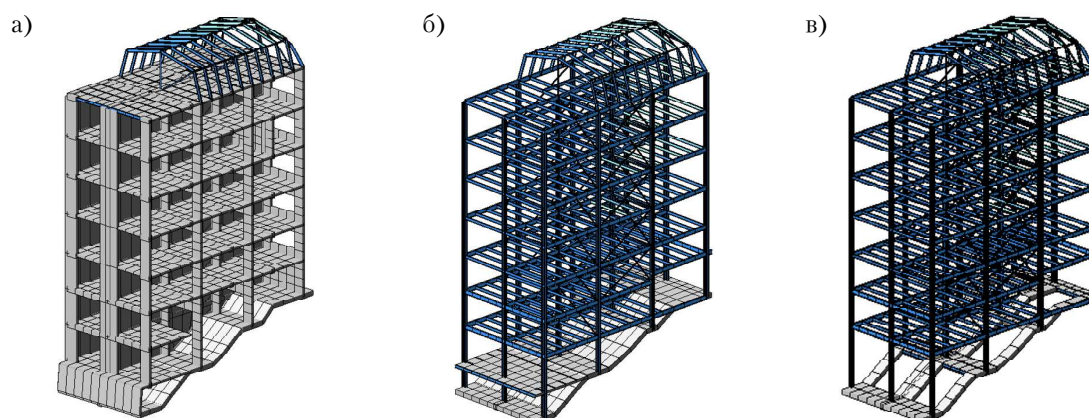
Общий вид компьютерных моделей здания: а) здание из монолитного железобетона, опирающееся на плитный фундамент; б) здание с металлическим каркасом по рамно-связевой схеме, опирающееся на плитный фундамент; в) здание с металлическим каркасом по рамно-связевой схеме, опирающееся на ленточный фундамент.
